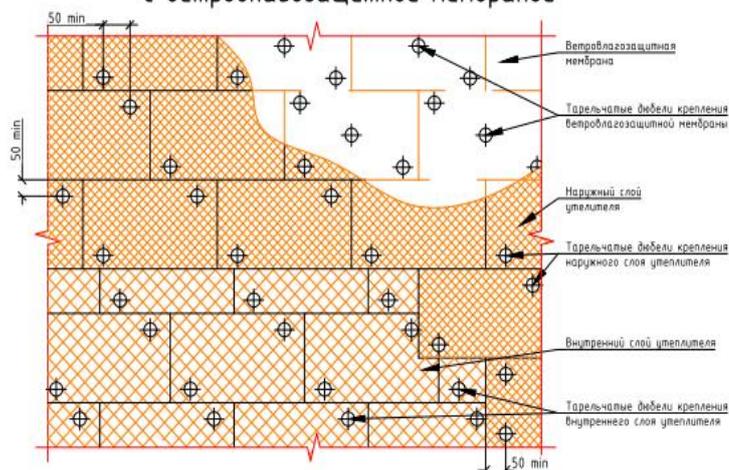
Схема установки двухслойного утеплителя с мембраной
